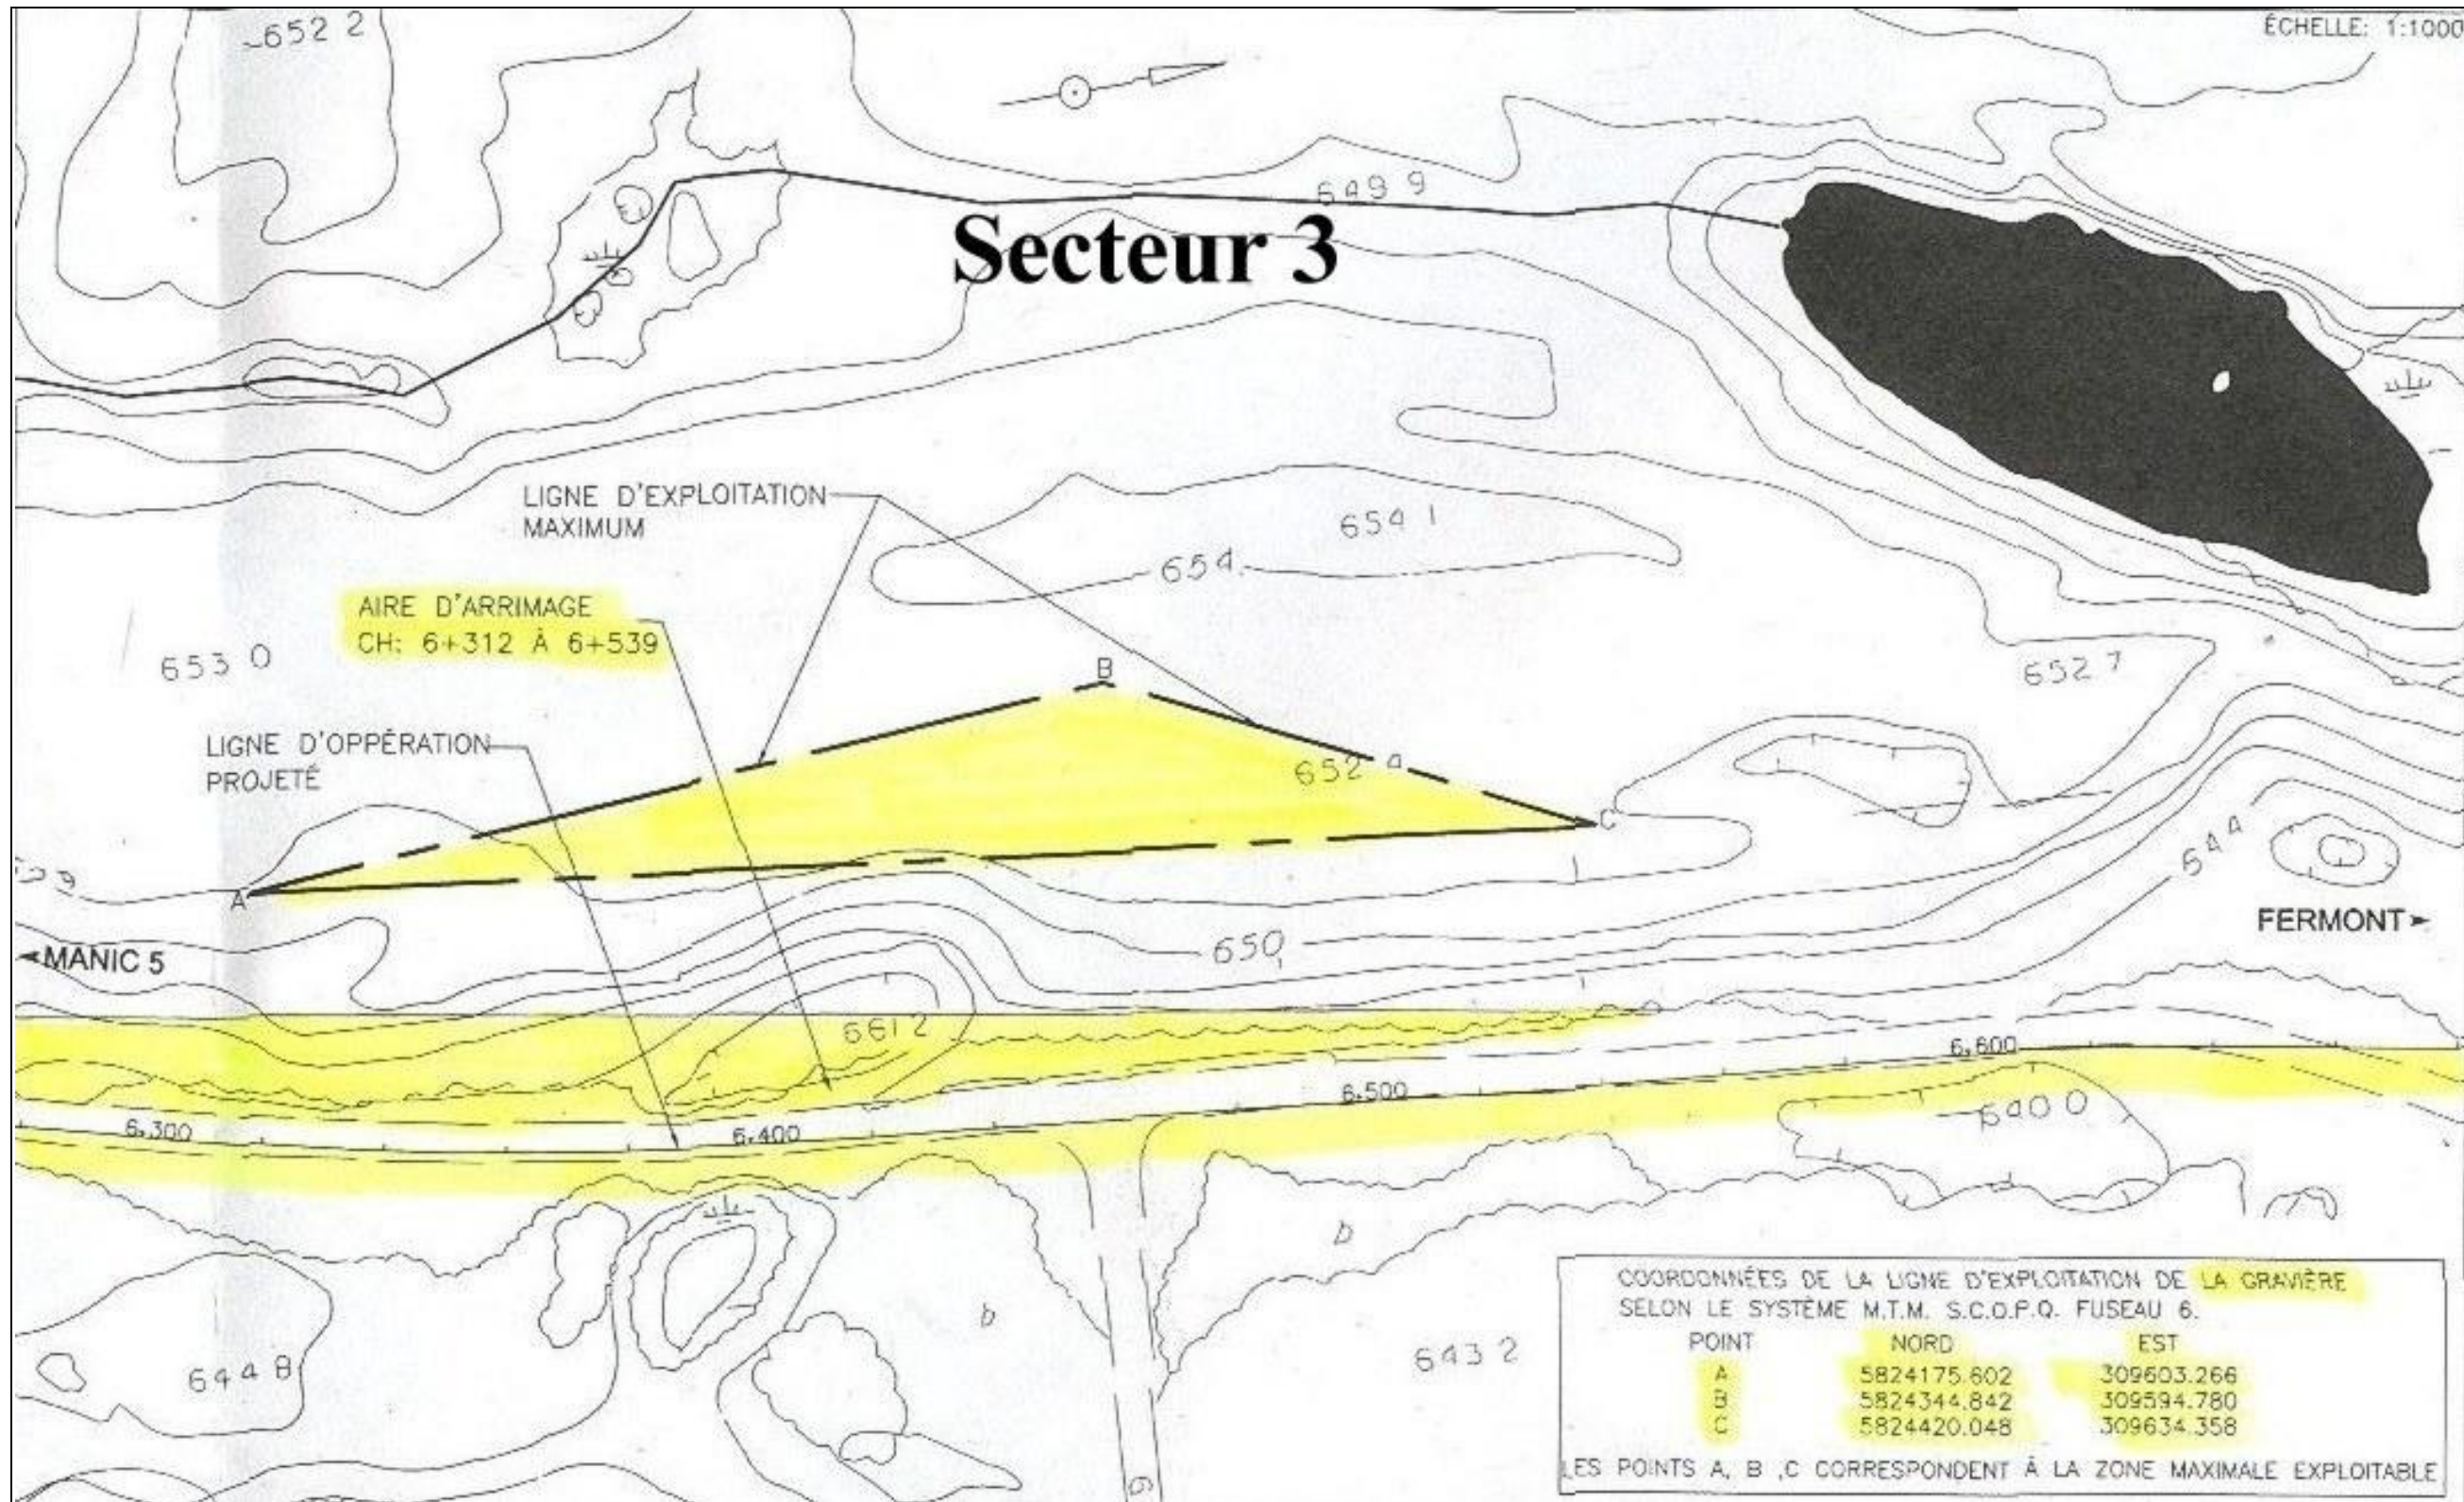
projet 154-07-0362, municipalité de Rivière-Mouchalagane, route 389, plan de construction et secteur d'inventaire (source : Transport Québec).
